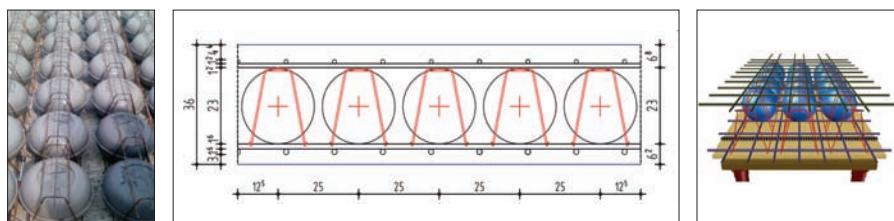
Detalii constructive planșee COBIAX - BUBBLEDECK
